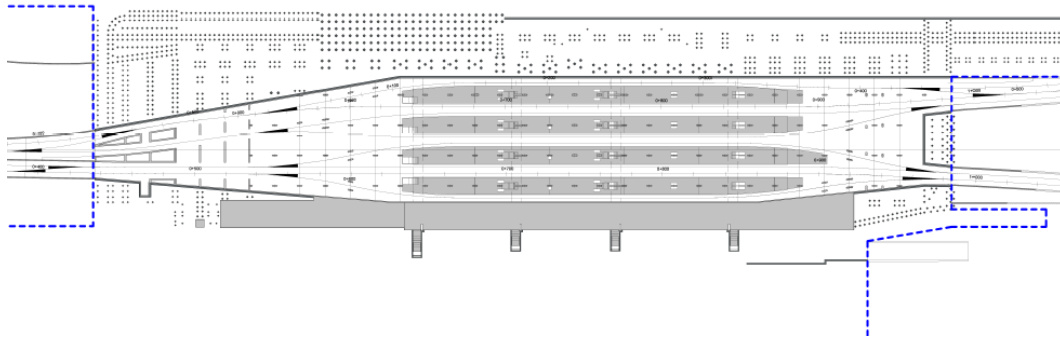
Planta del nivel inferior de la estación de La Sagrera (Fuente: Proyecto Original).
